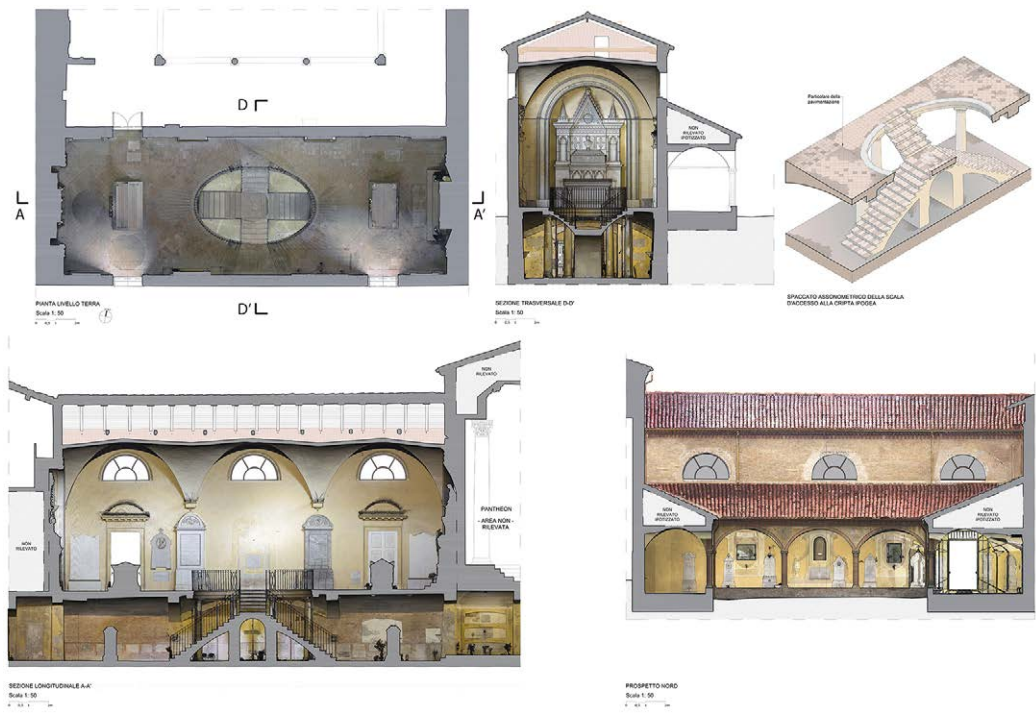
Rappresentazione in pianta, sezione, prospetto della Sala e assonometria di una porzione della scala. Elaborazioni degli autori.
